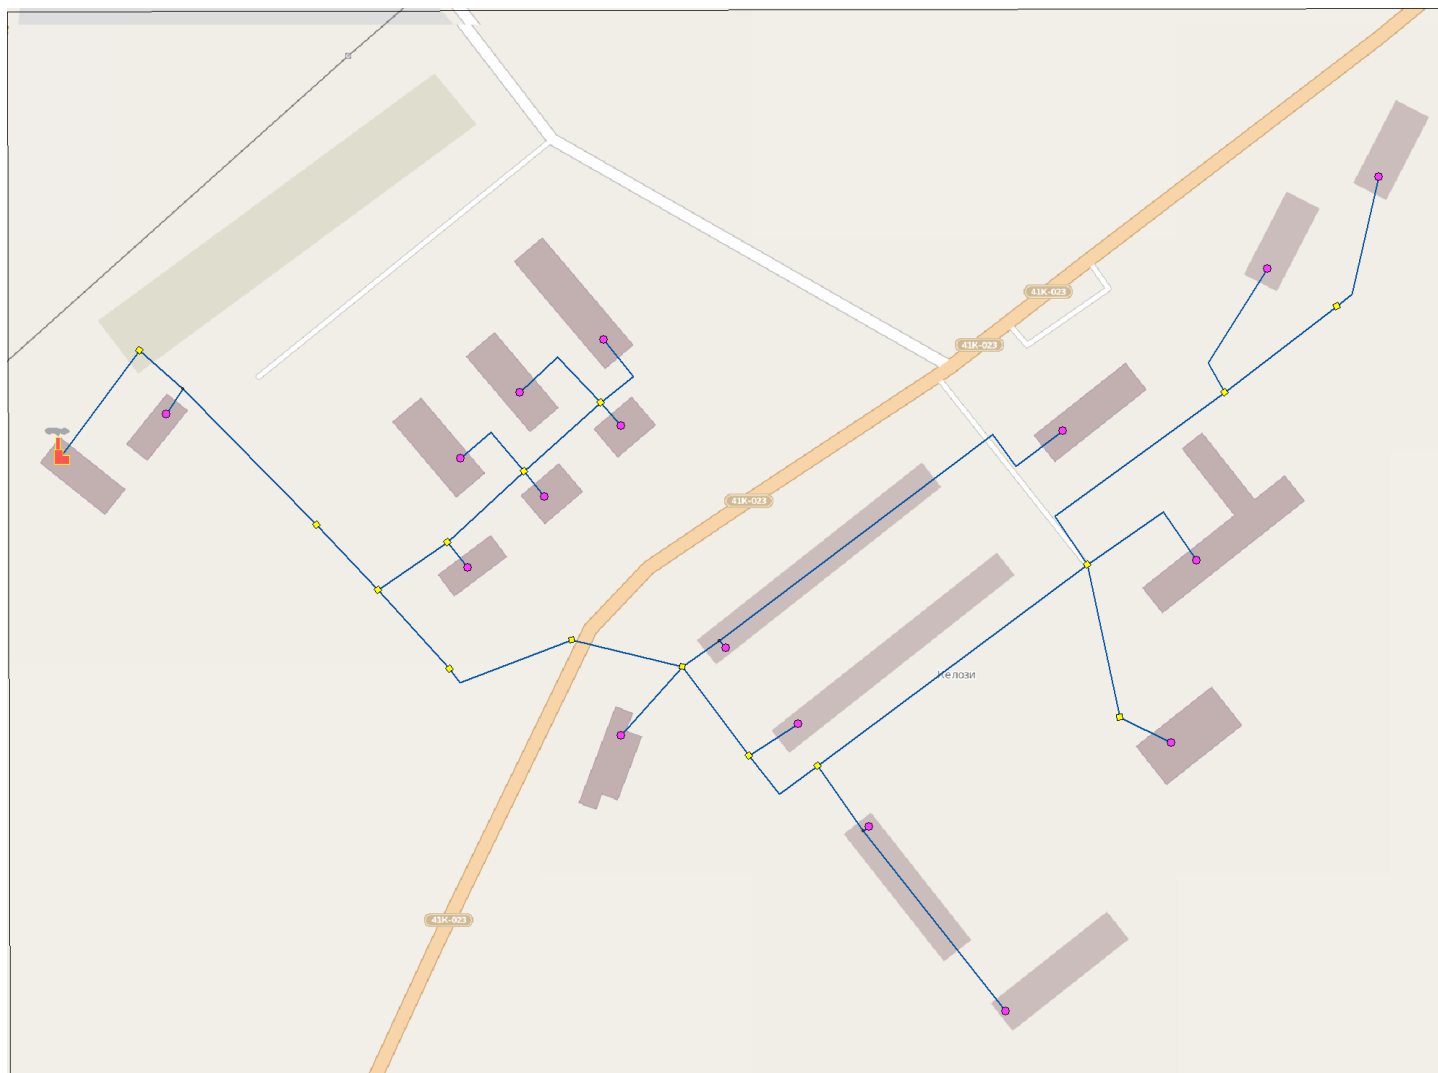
Схема прокладки тепловых сетей от котельной Келози
